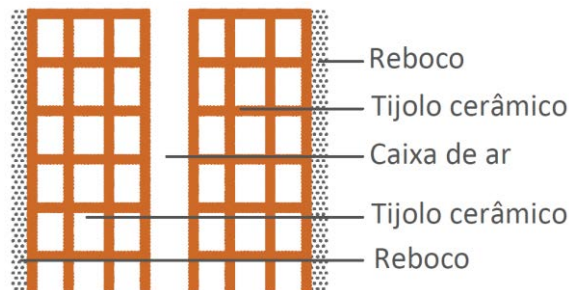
Solução construtiva tipo de parede para edifícios adjacentes – Pré intervenção
